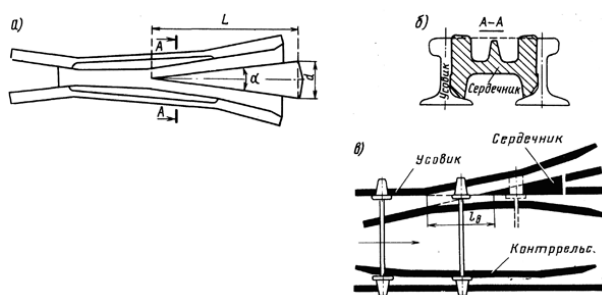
Сборная крестовина с литым сердечником в виде общей отливки с изнашиваемой частью усовиков: а – план; б – сечение крестовины; в – направление колес в желоб крестовины контрольным; L_b – «вредное пространство»
